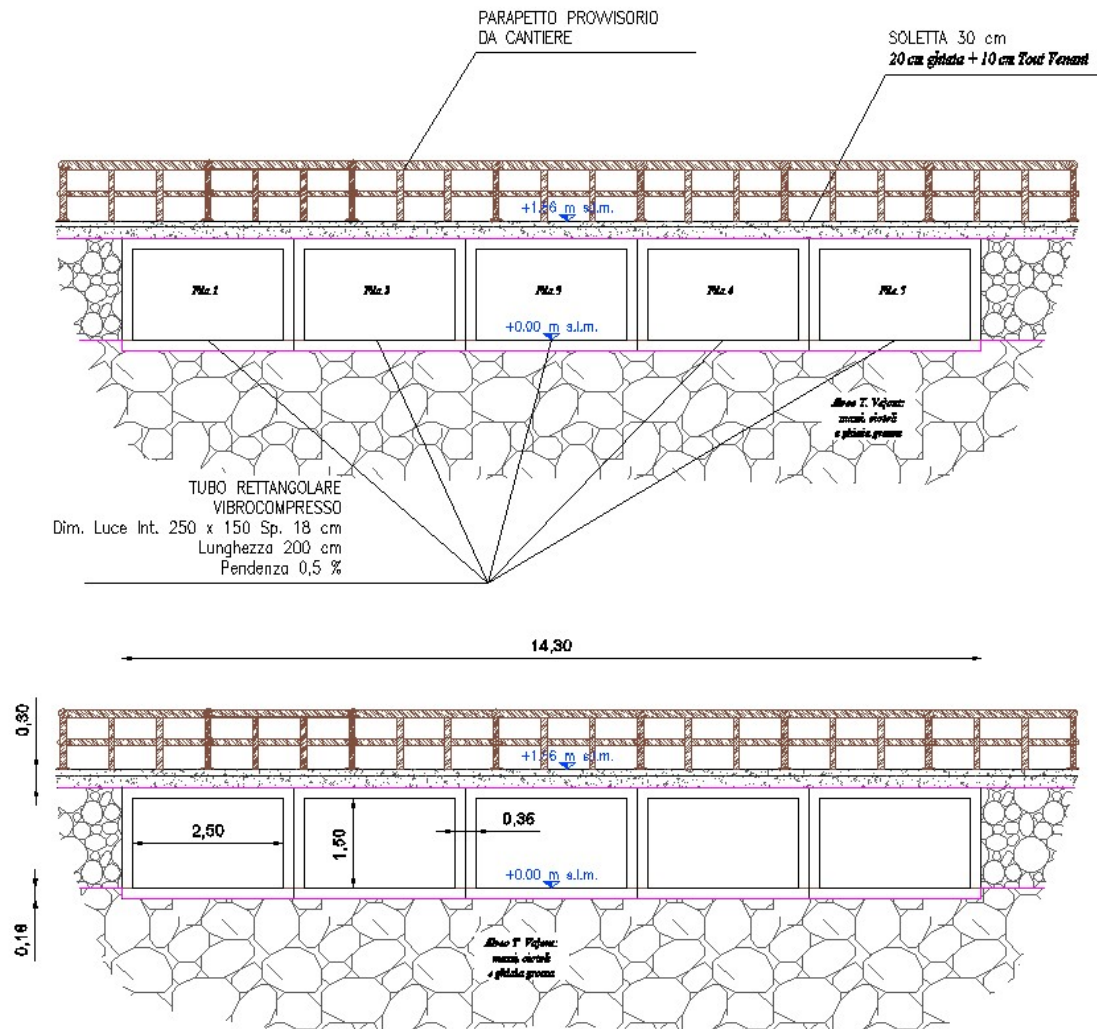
Sezione tipo dei guadi – attraversamenti fluviali.
